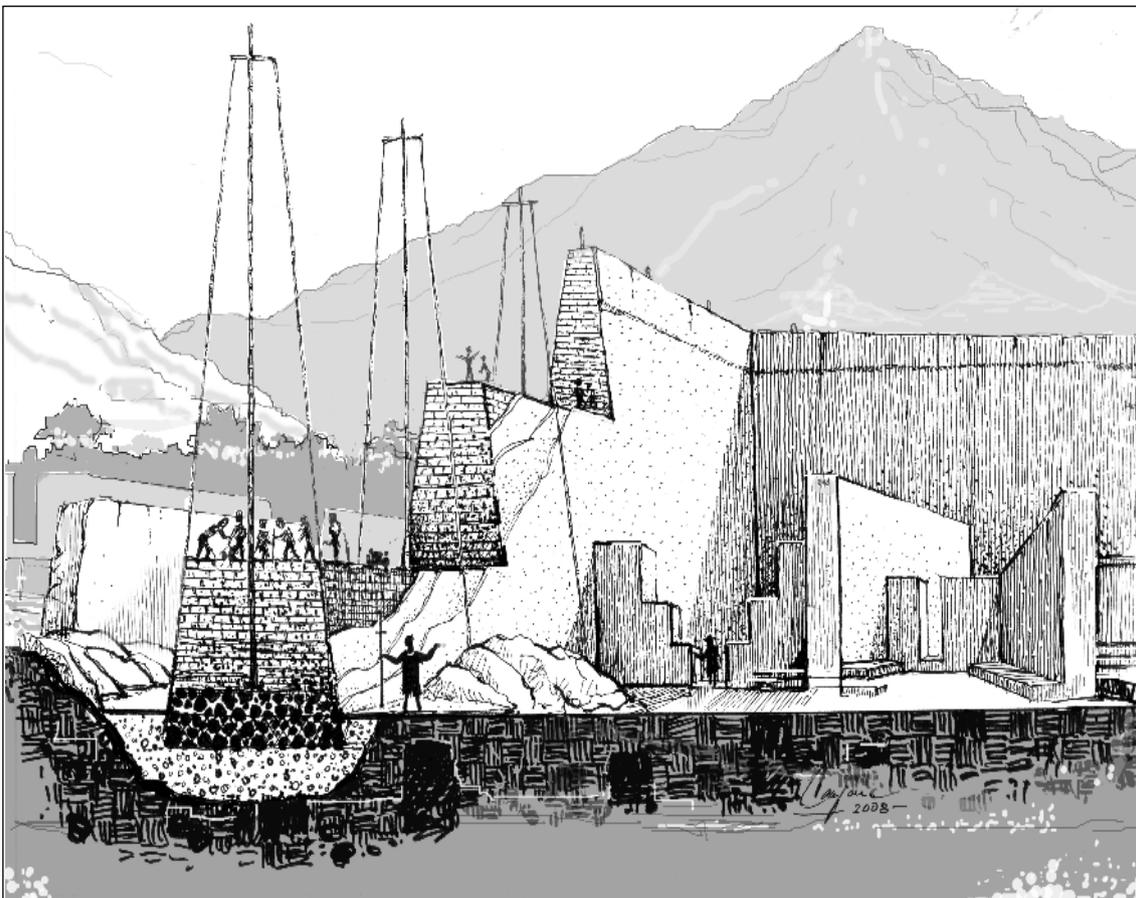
Dibujo mostrando la existencia de cuatro niveles en la construcción de un muro perimetral externo: Una zanja con cascajo en seco. Sigue una especie de cemento con piedras grandes y barro para nivelar la construcción, luego un sobre cemento con hormigón prensado y finalmente un muro de adobes de tres dimensiones.
